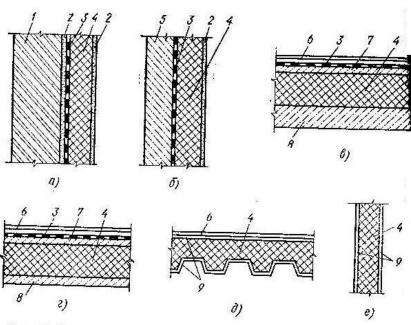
Схемы изоляции ограждающих конструкций зданий холодильников:
